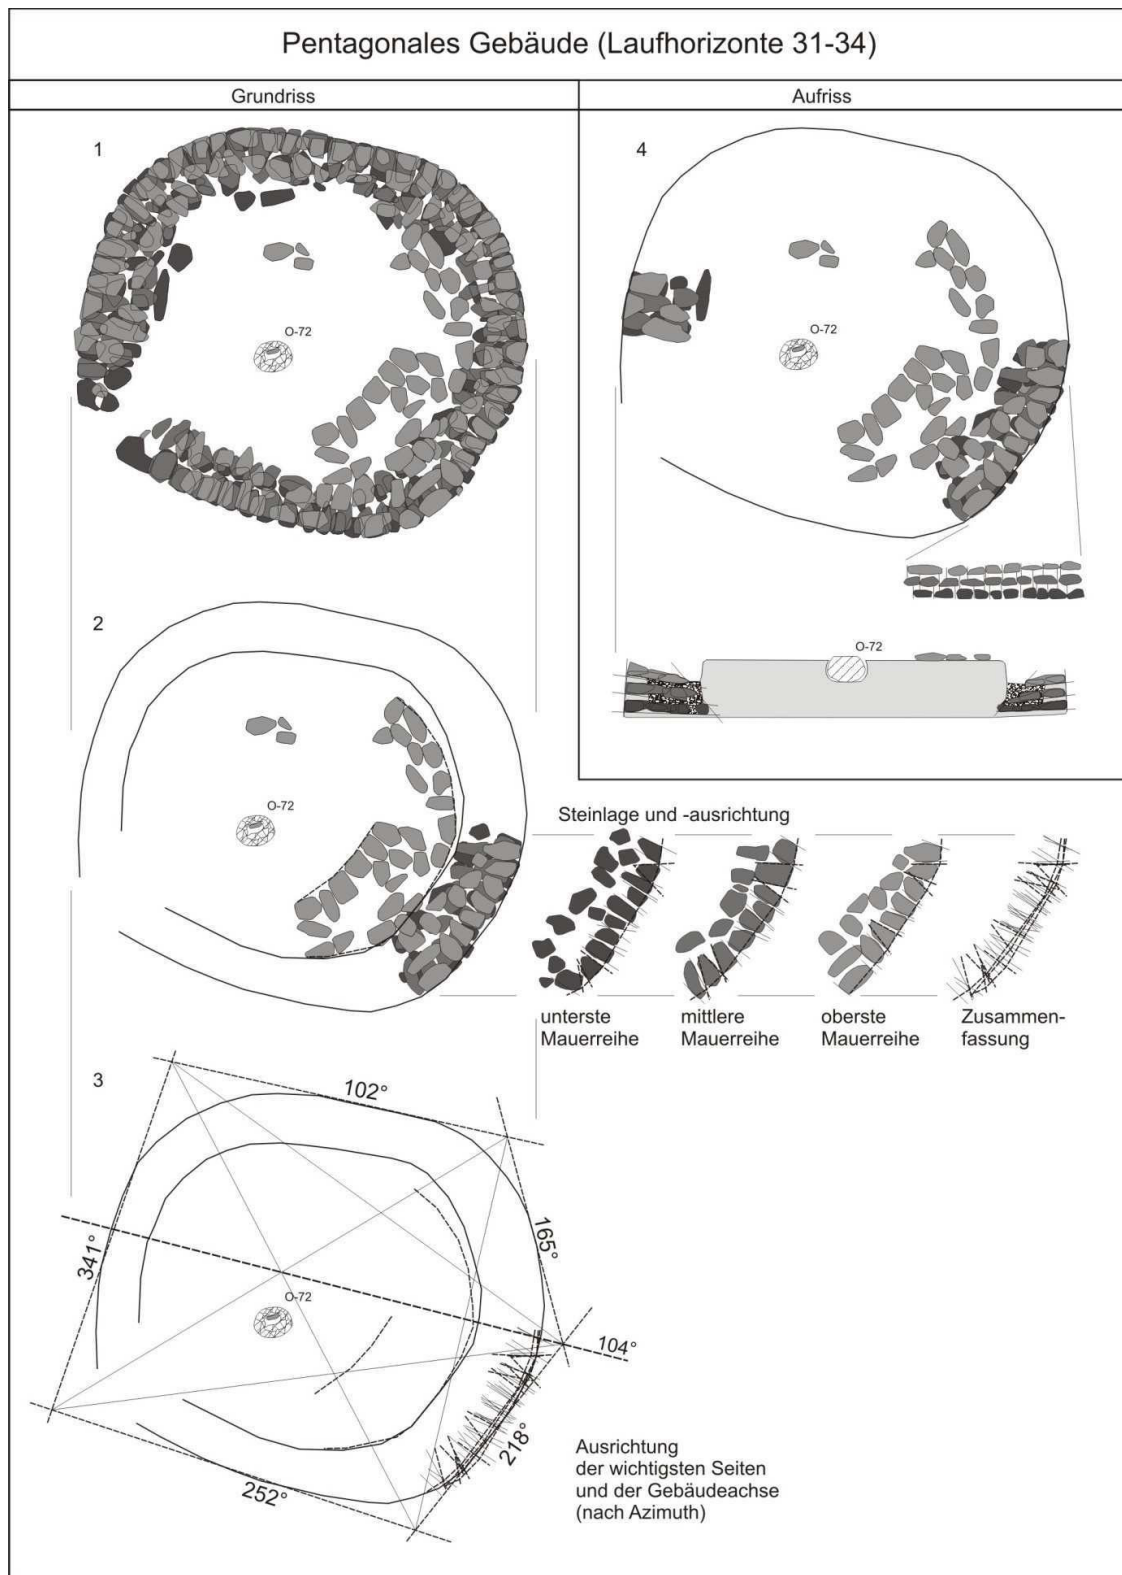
Grundriss und Aufriss des pentagonalen Gebäudes (M-67).
